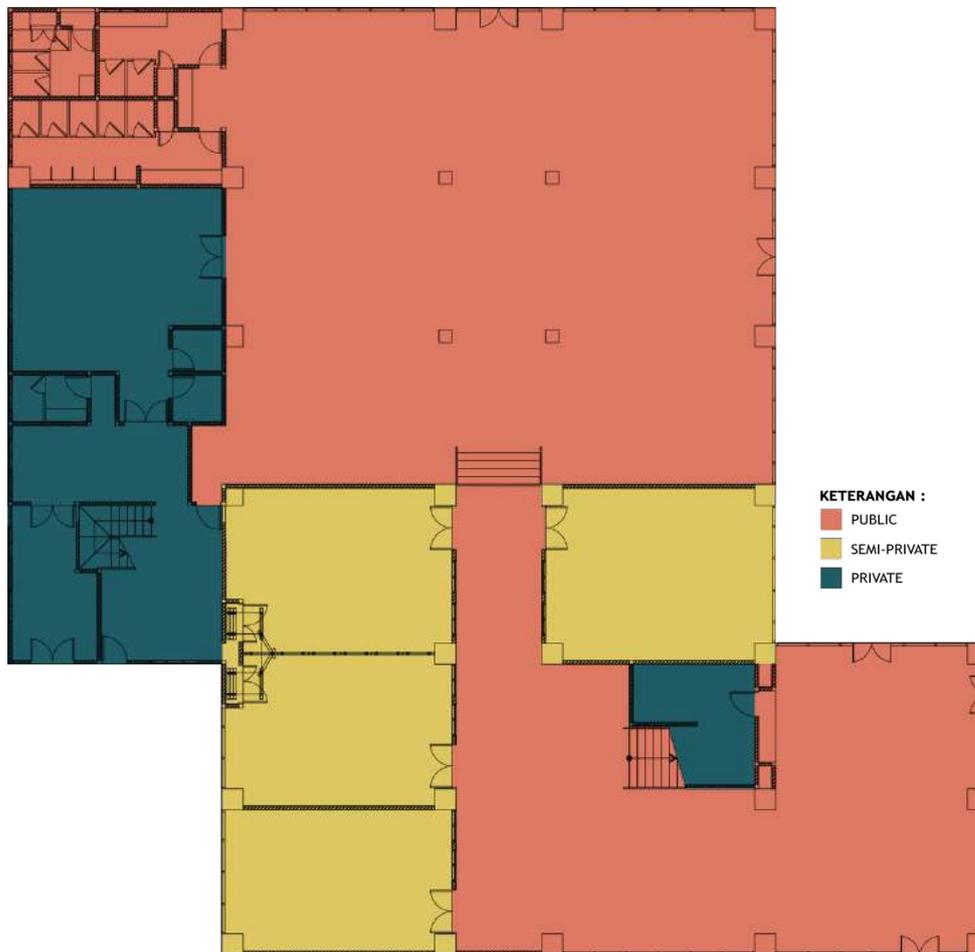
Denah Eksisting lantai 2 Ruang Pelatihan TCC Yogyakarta
